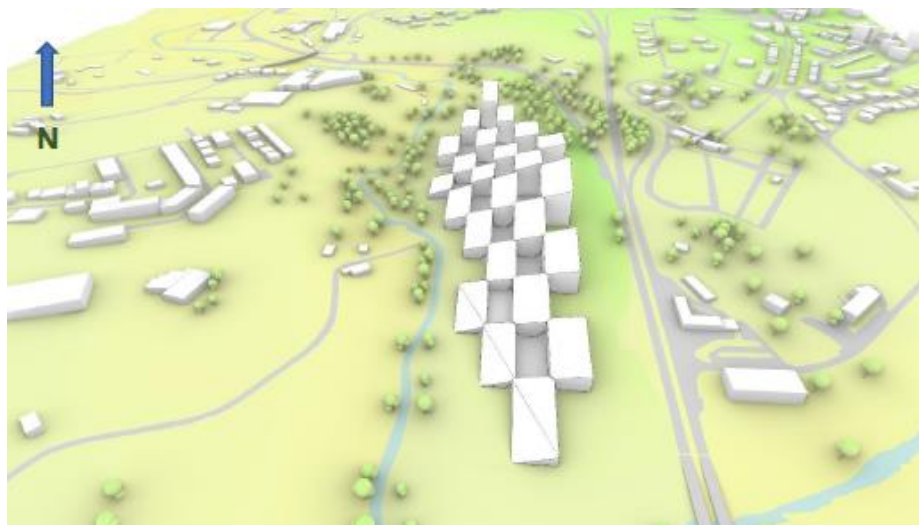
Cenalização 3D das implantações do Loteamento - perspetiva sul para norte (sem escala) (Fonte: Aditamento ao EIA - outubro de 2021).
